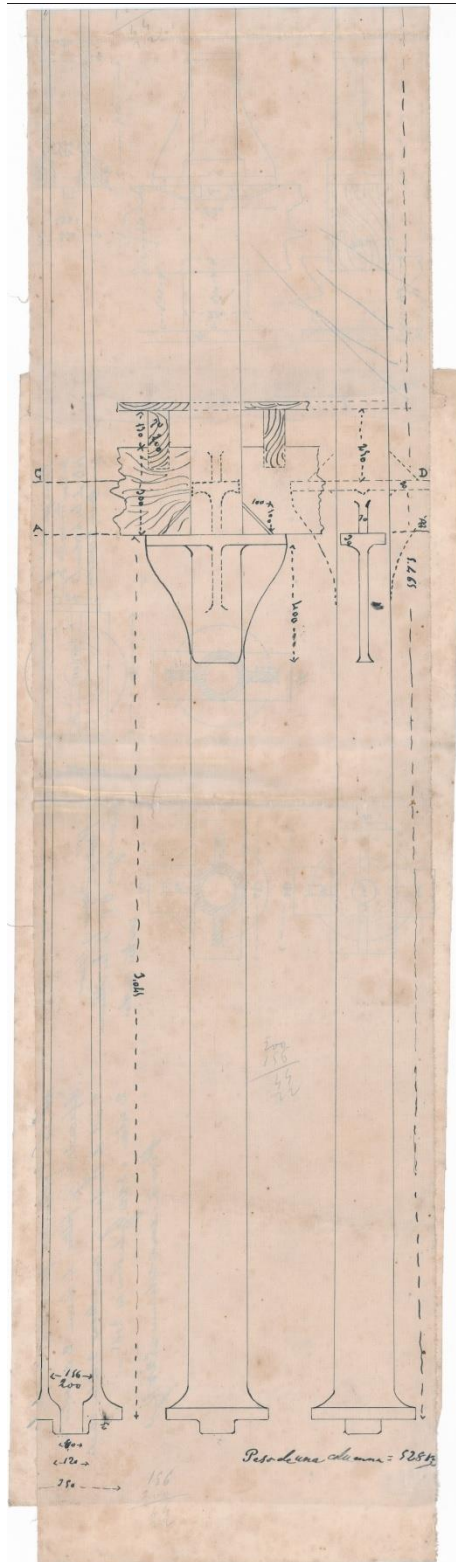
Proyecto del Ingenio de San Juan: detalle en alzado de prolongación de pilares a través del forjado.
